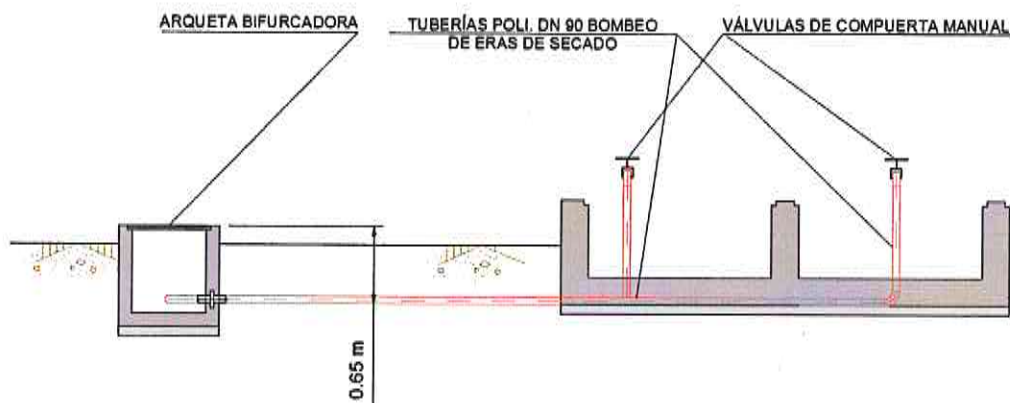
Esquema del montaje a la era de secado. Fuente: Elaboración propia
